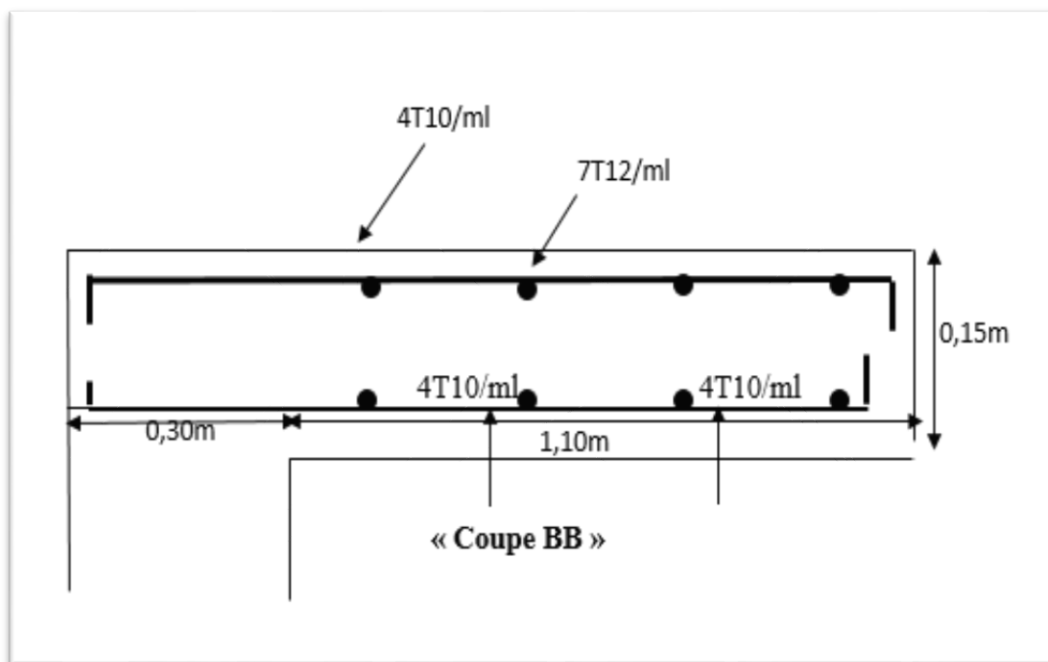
Coup transversale de ferrailage de dalle pleine
